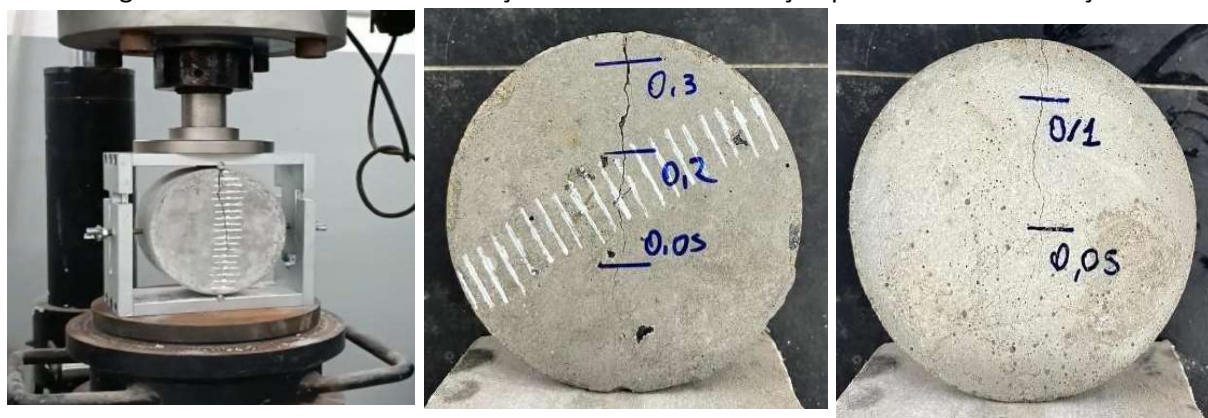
Procedimento de fissuração induzida e mensuração para devida classificação
